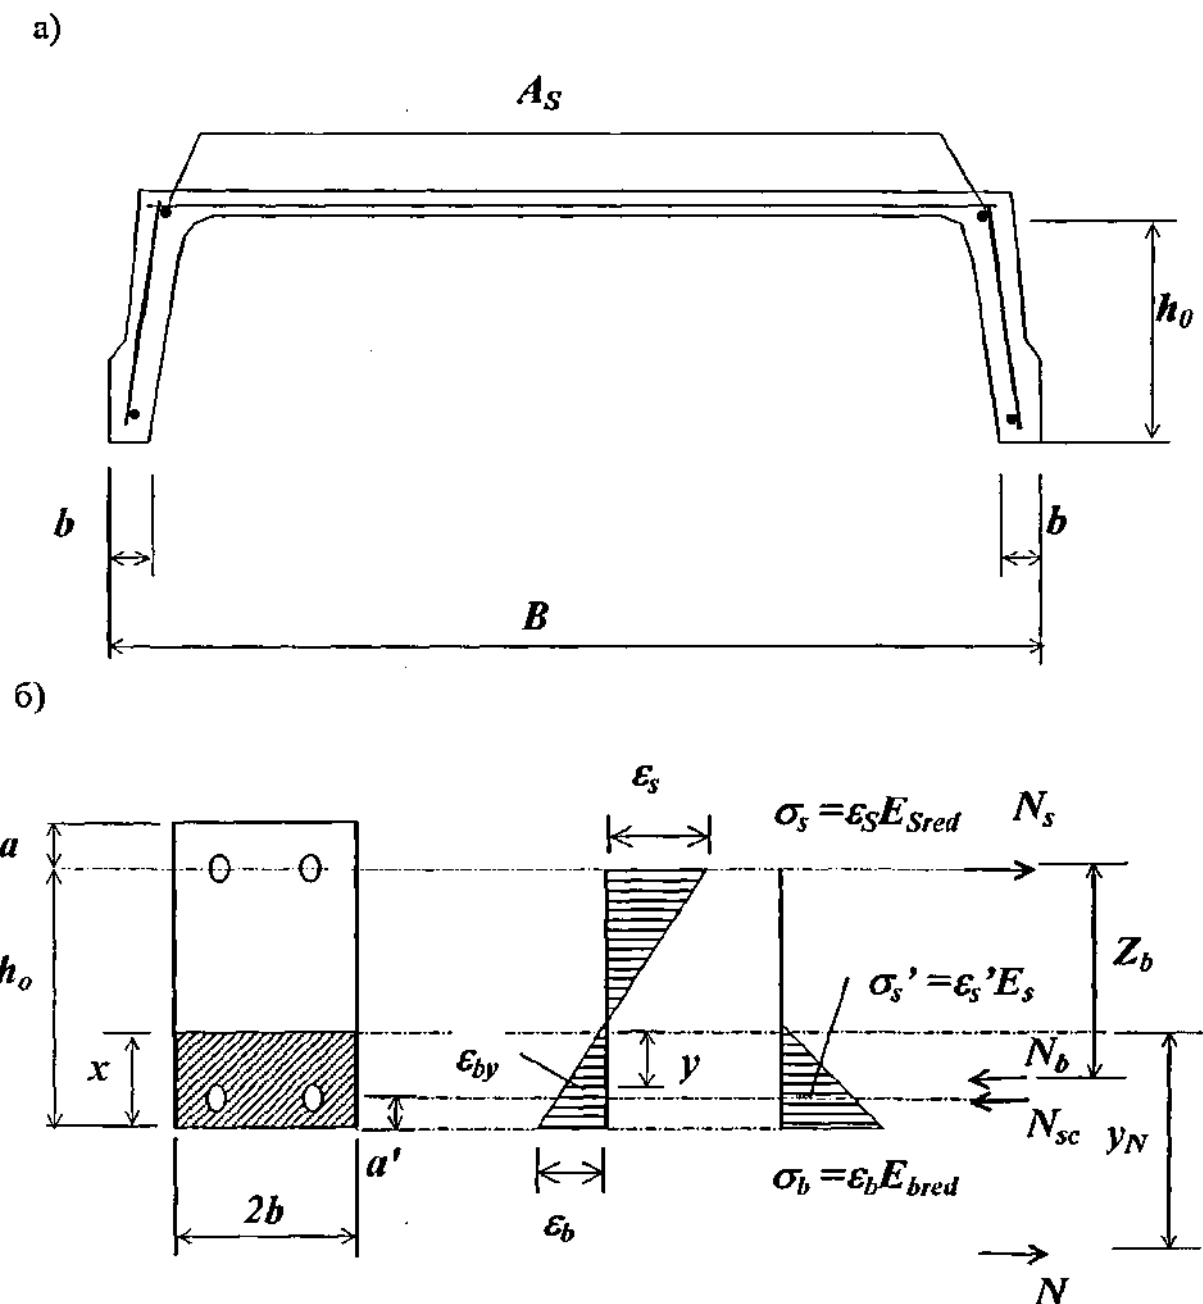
Геометрія поперечного перерізу плити (а) і розрахункова схема (б)
